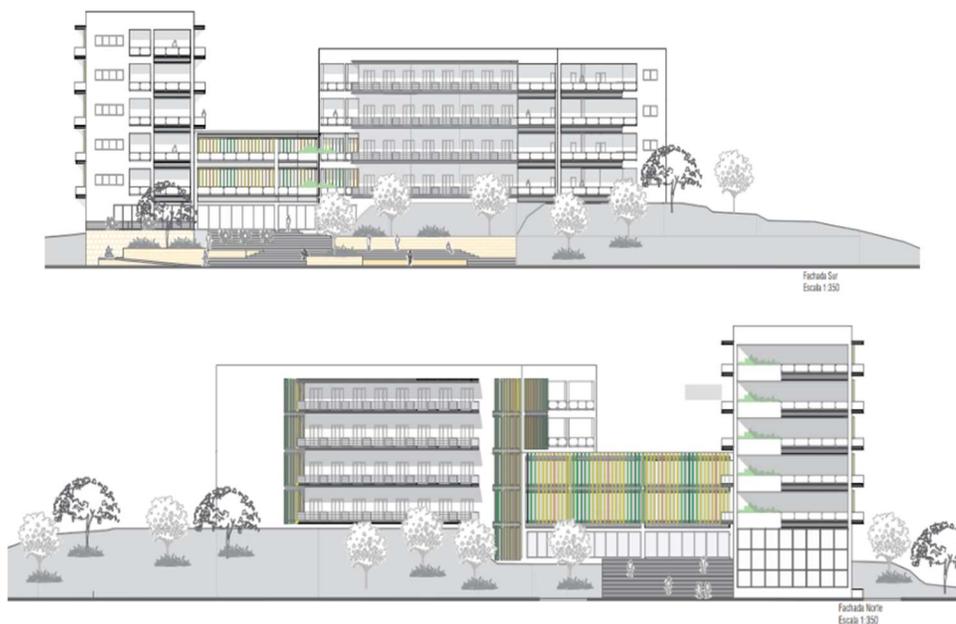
Fachada Norte y Fachada Sur de la Residencia
